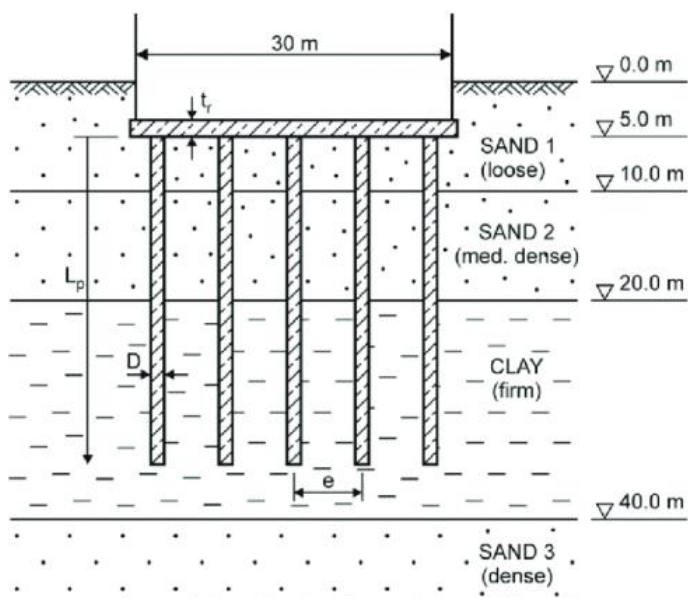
Схема пальового фундаменту з плитою-ростверком [38].
